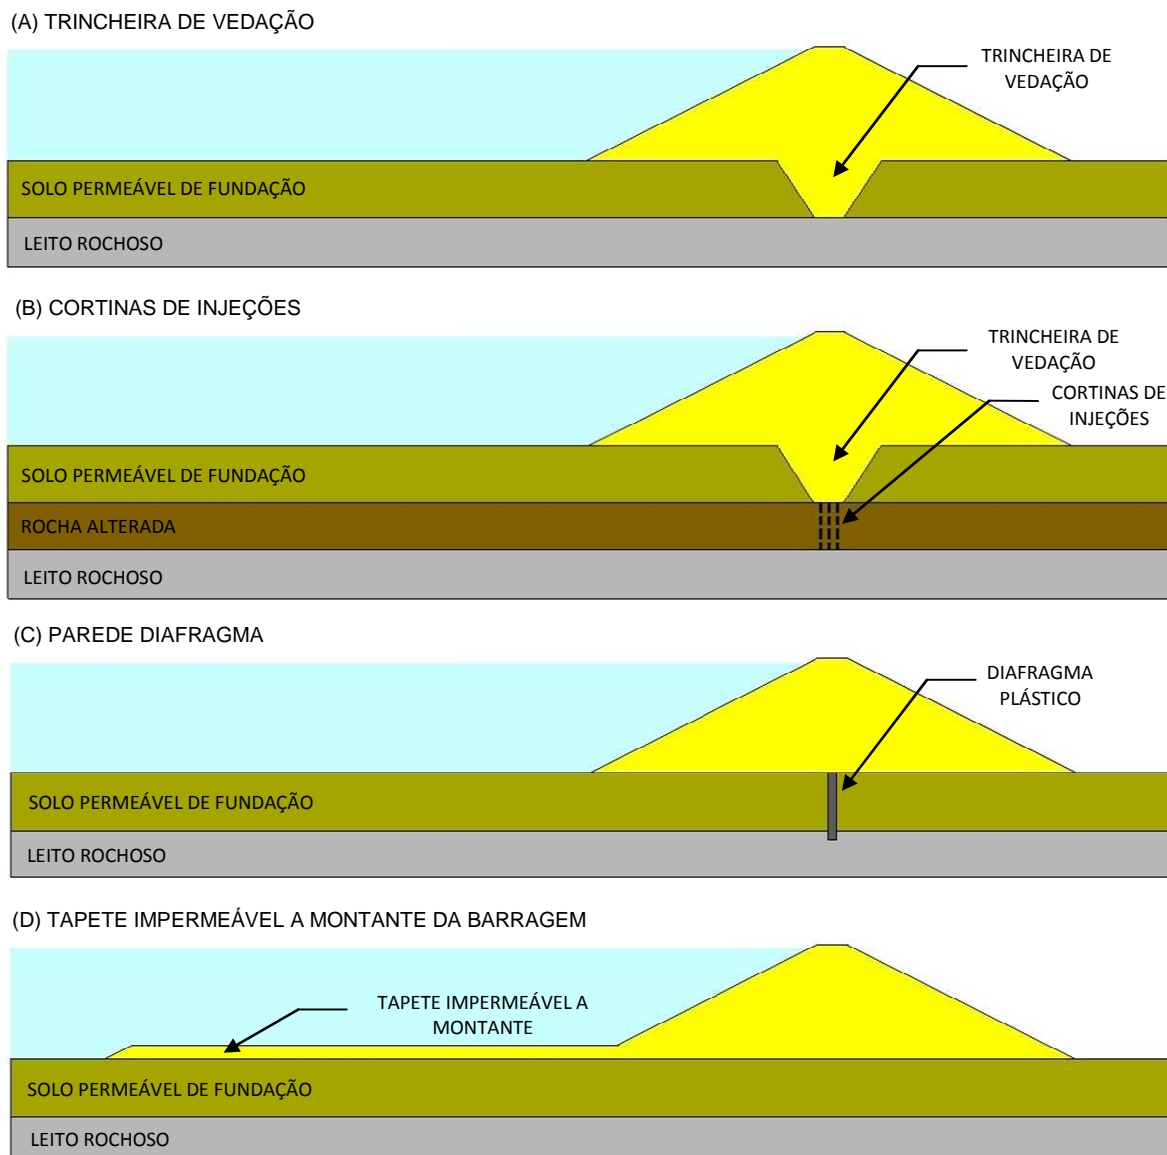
Tratamento de fundação através de: (A) Trincheira de vedação (*Cut-off*); (B) Cortinas de injeção; (C) Parede diafragma, e; (D) Tapete impermeável a montante da barragem
